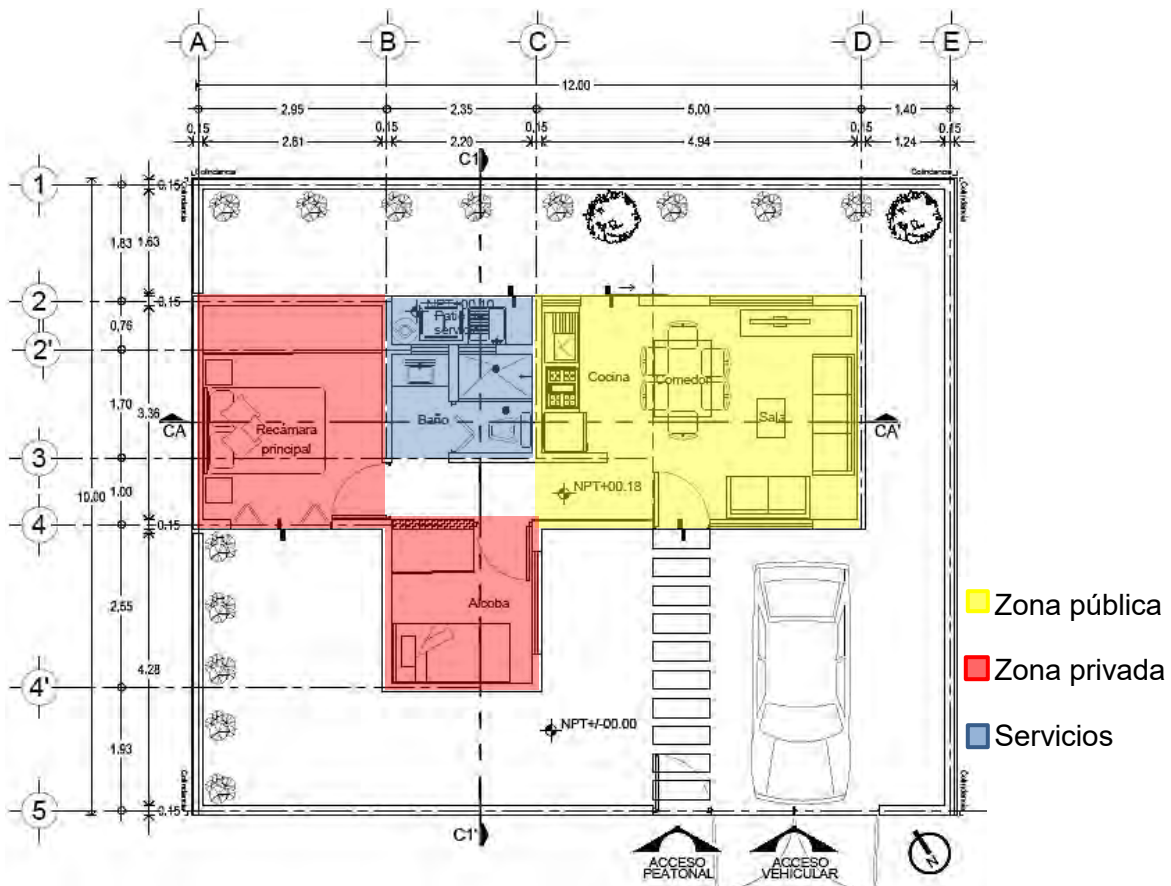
Planta arquitectónica de prototipo de vivienda C2. Primera etapa, planta baja.
